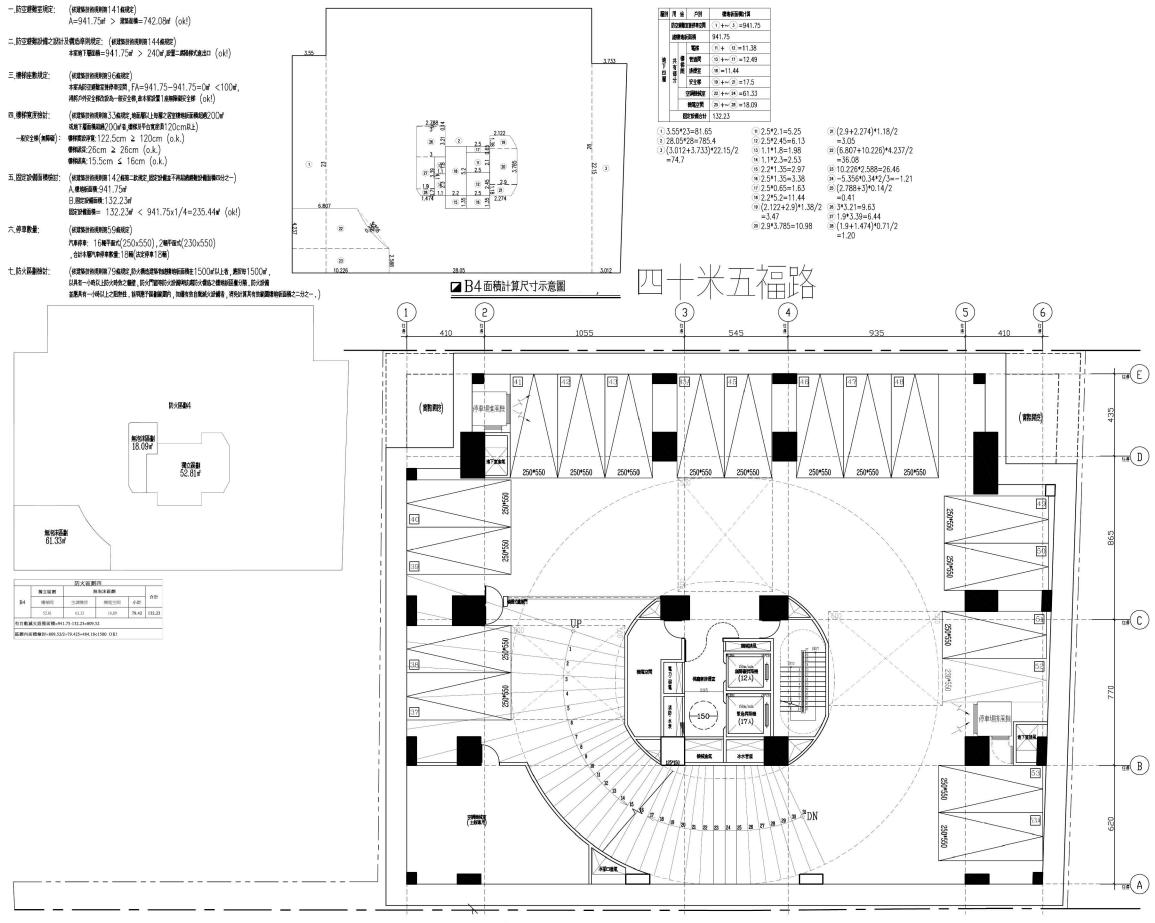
地下 4 層平面圖 (比例尺 1/200)
